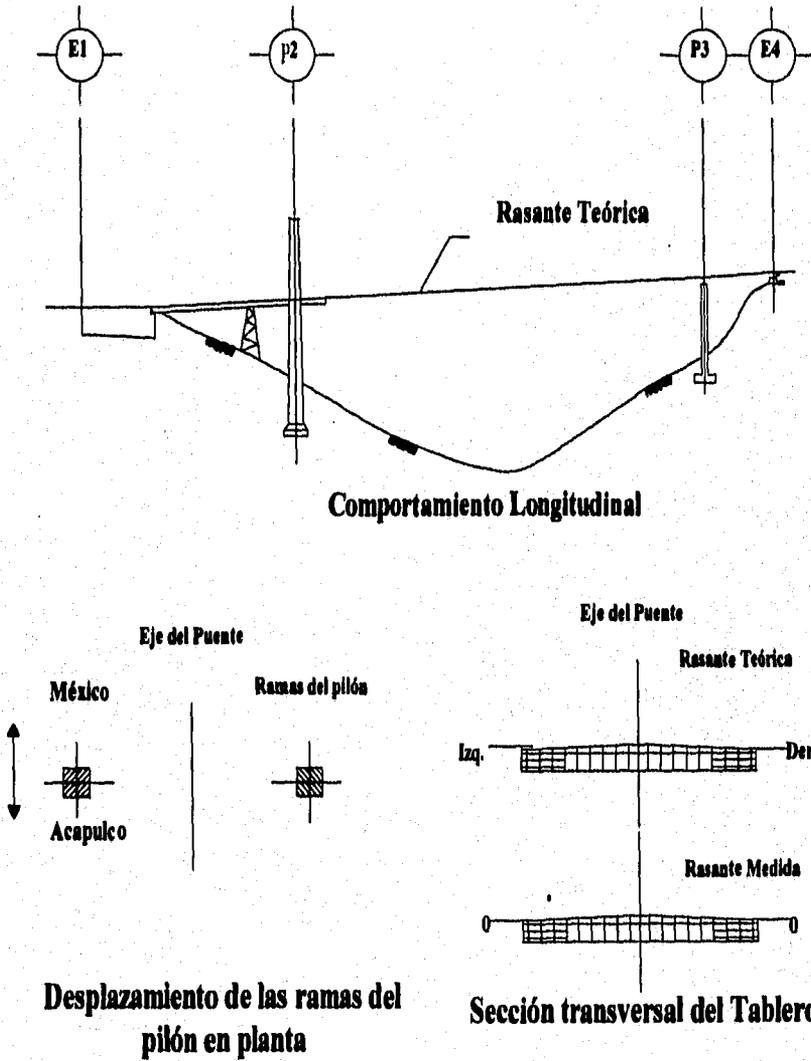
Deformaciones medidas al final del Tramo Empujado 1 -2
